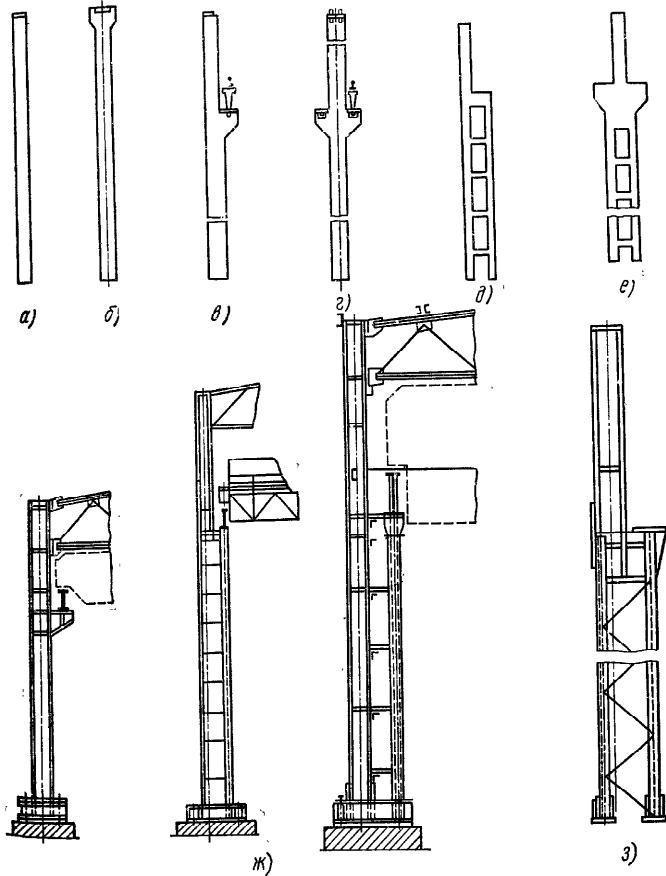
Железобетонные (*а—с*) и металлические (*ж, з*) колонны:
